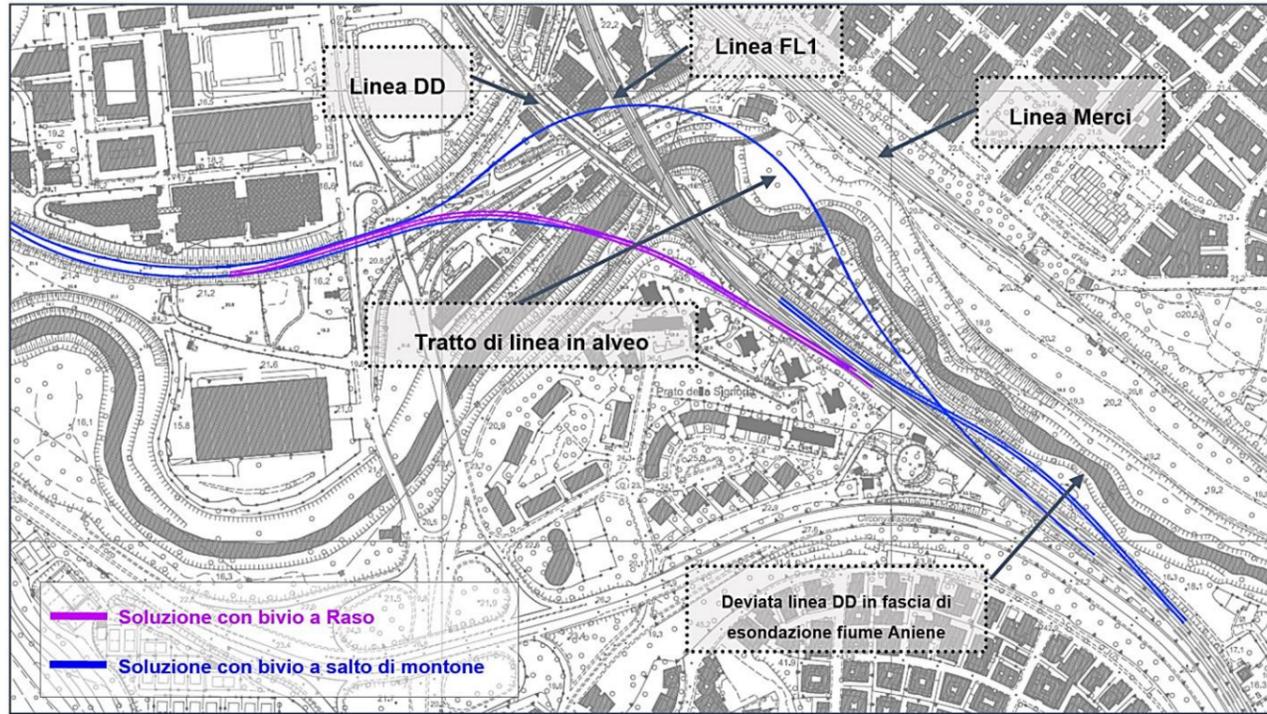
Planimetria alternative di progetto dell'innesto su linea FL1
